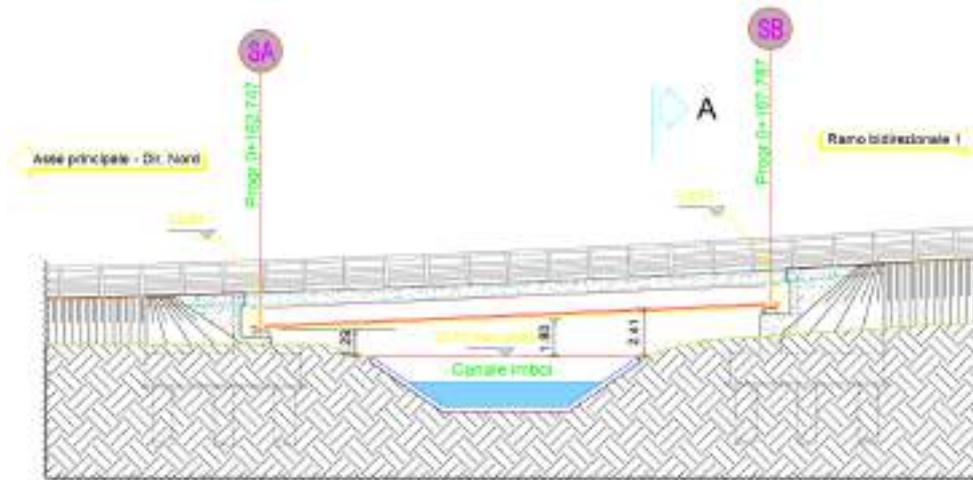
Prospetto del ponte su canale Imboi svincolo Capoterra - Casic ramo A.
